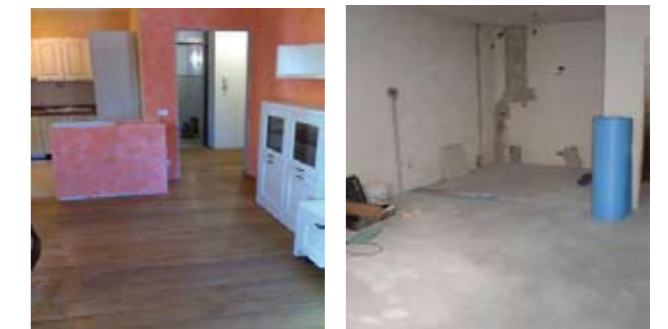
Posa dello strato acustico anticalpestio e del pavimento flottante
